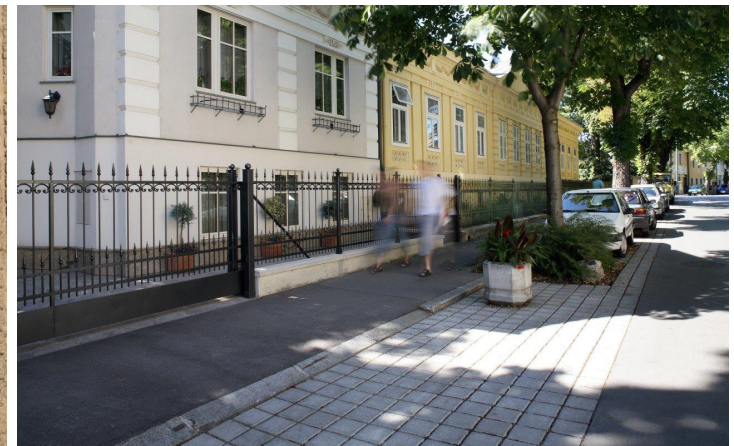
Geschlossenporige Sickerpflaster mit geprüftem Schadstoffrückhalt, Straubing
